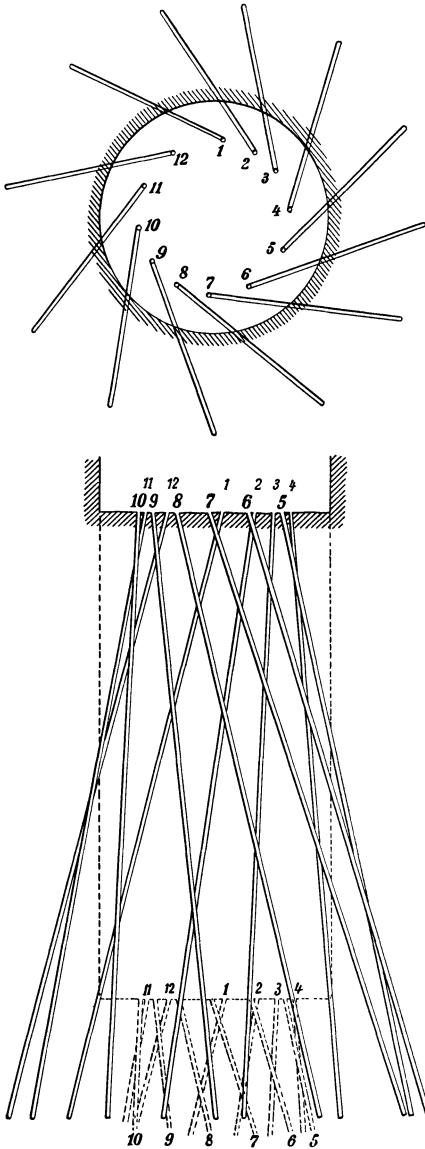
Schräger Ansatz und Verlauf der Bohrlöcher für Zementierung des Gebirges bei Schachtabteufen.
